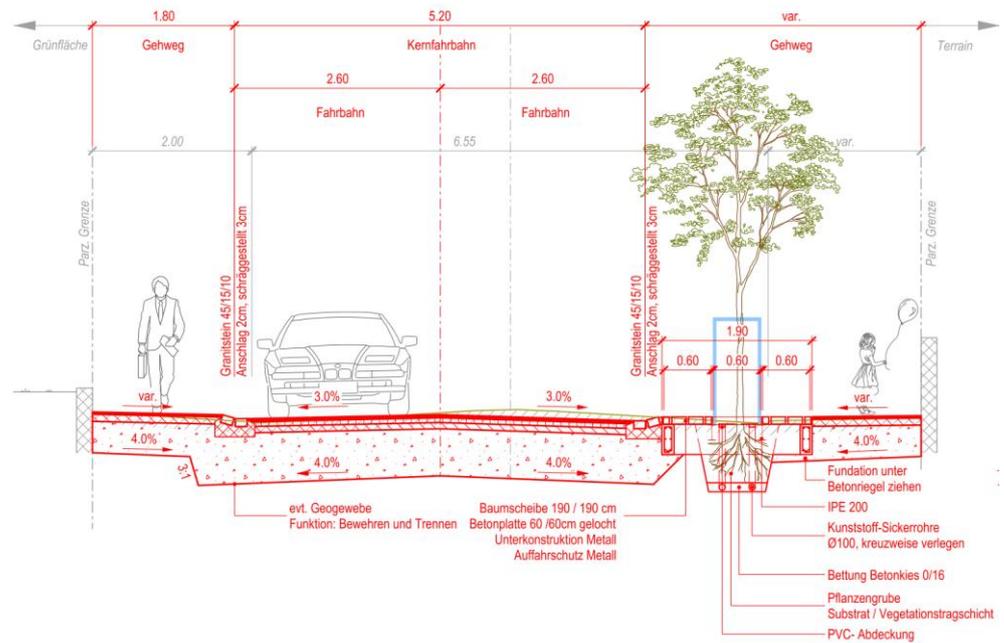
, Baumgrube gemäss Design Team crossbow, Planausschnitt B&H
